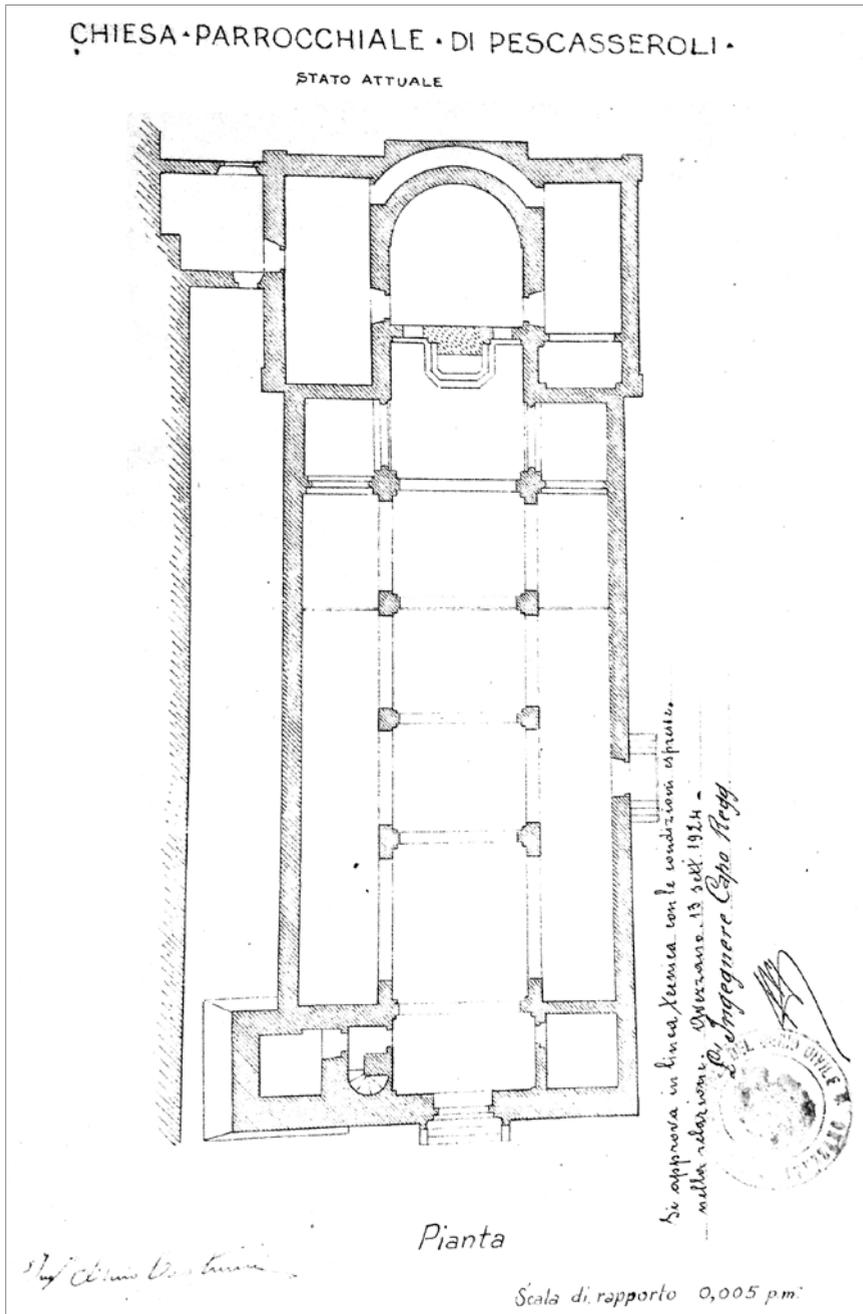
Pescasseroli, rilievo della chiesa dei Santi Pietro e Paolo (Archivio di Stato di Avezano, Sezione Genio Civile, b. 84, G. Buttarelli «Progetto di restauro della chiesa parrocchiale di Pescasseroli. Proposta di variante nell'esecuzione del progetto approvato. Relazione Tecnica»)
